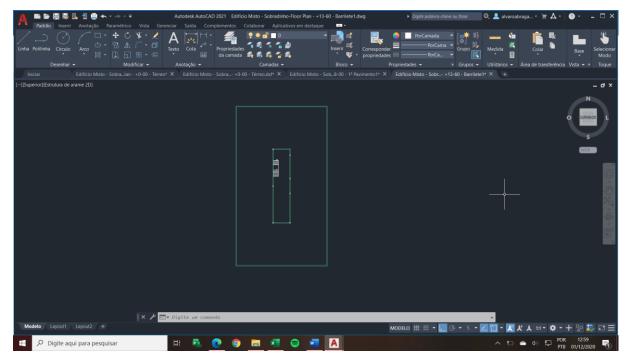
Planta baixa do barrilete, em DWG. Realizado pelo autor.
